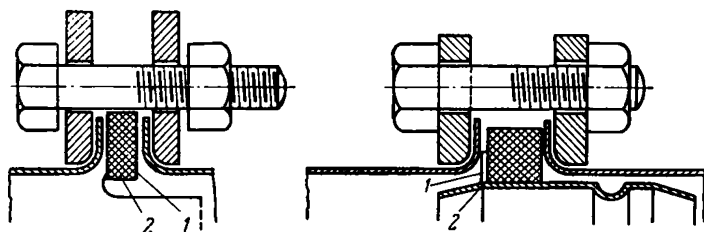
Фланцевые соединения, применяемые для вентиляционных трубопроводов из оцинкованного железа:
